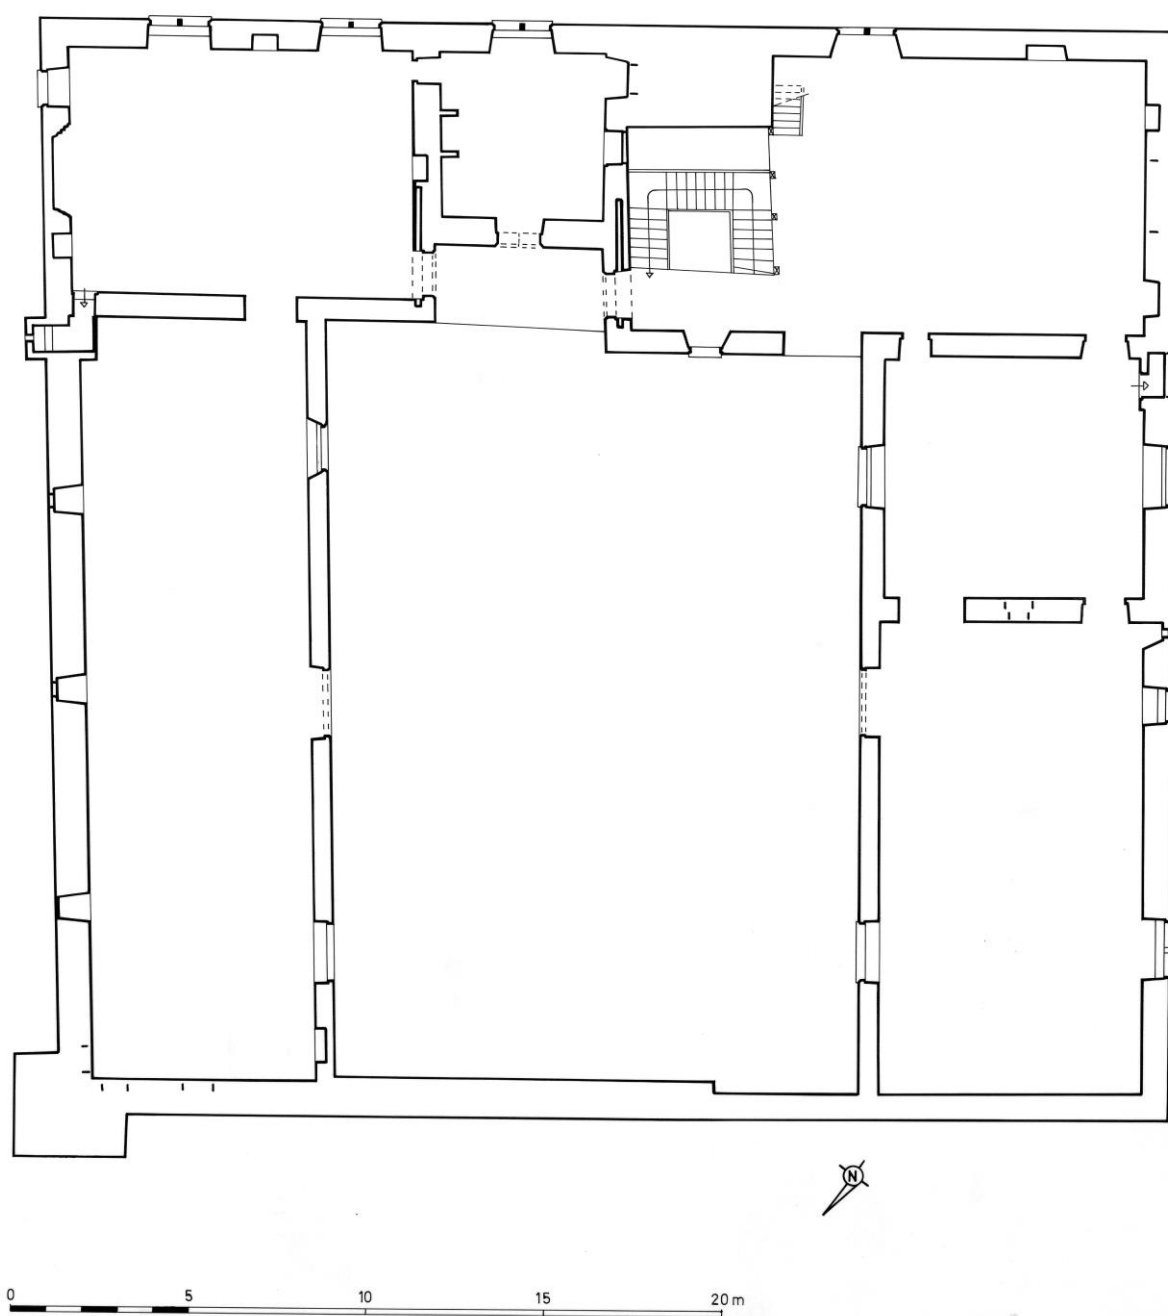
Relevé du plan du château par Patrick Roques (1997) : premier étage.
